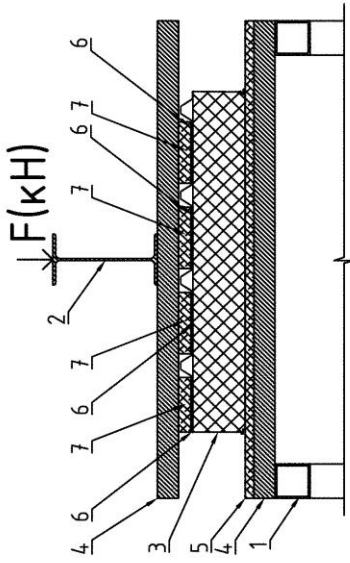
Схема испытания образцов кровельных сэндвич-панелей на
